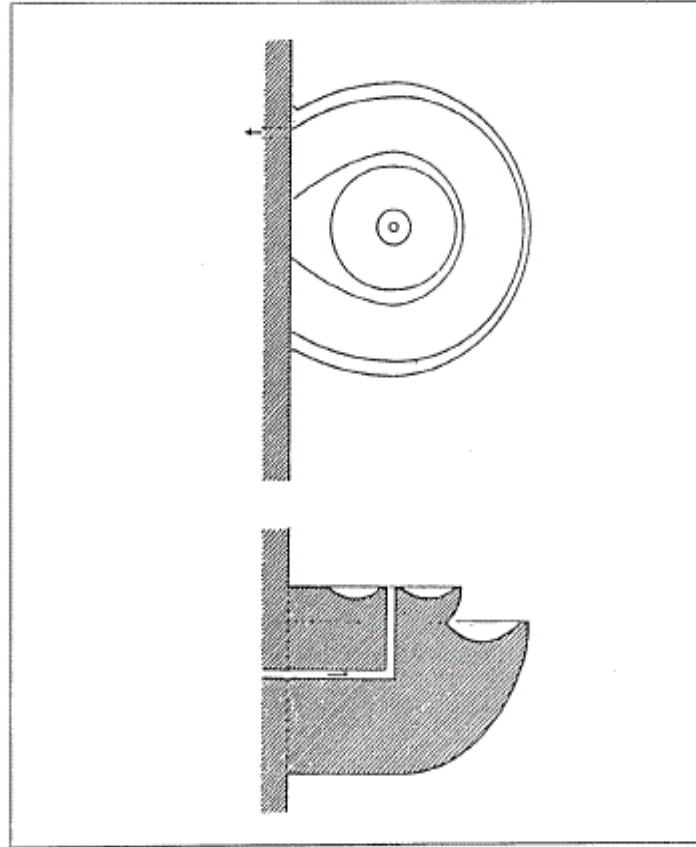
مسقط أفقي وقطاع لثربة خليل باشا الملحقة بمسجده في بانيا لوكا
